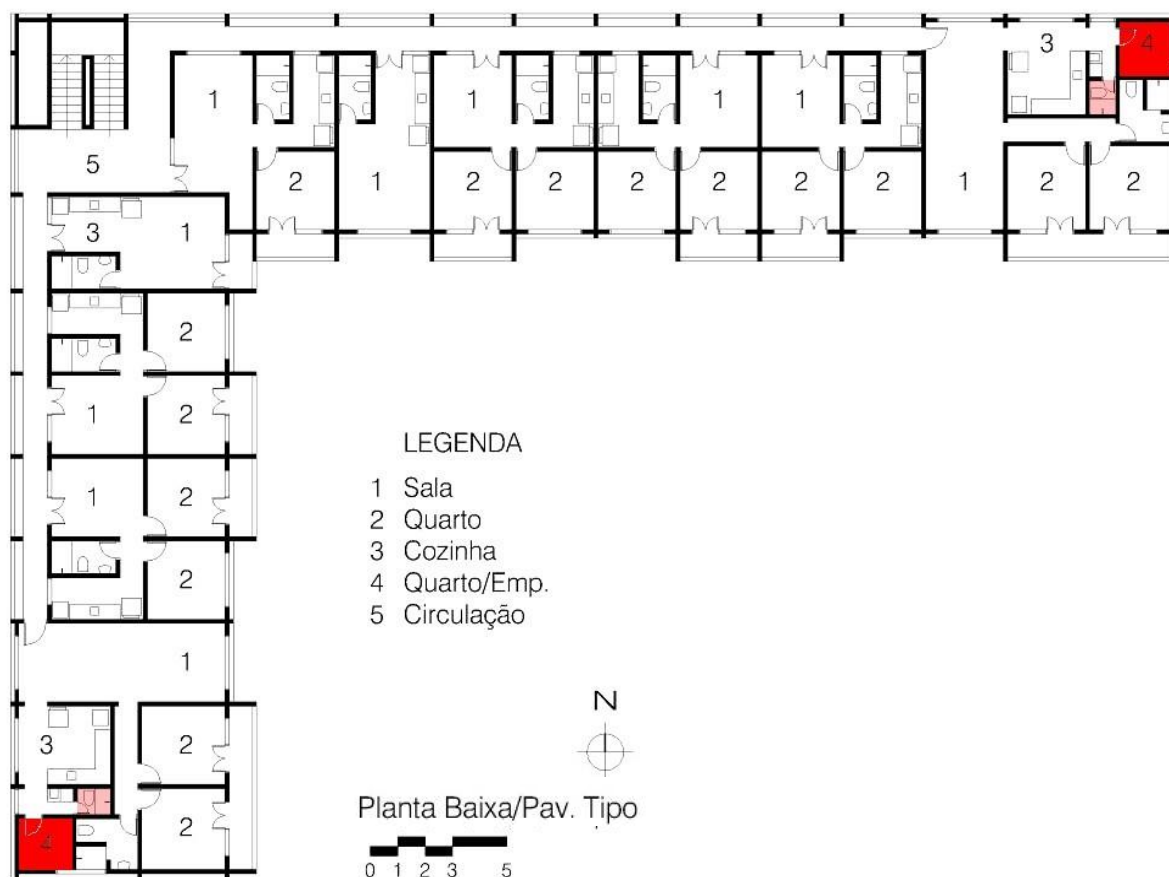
Planta-baixa do pavimento-tipo (1º e 2º andar) do edifício Santo Antônio
